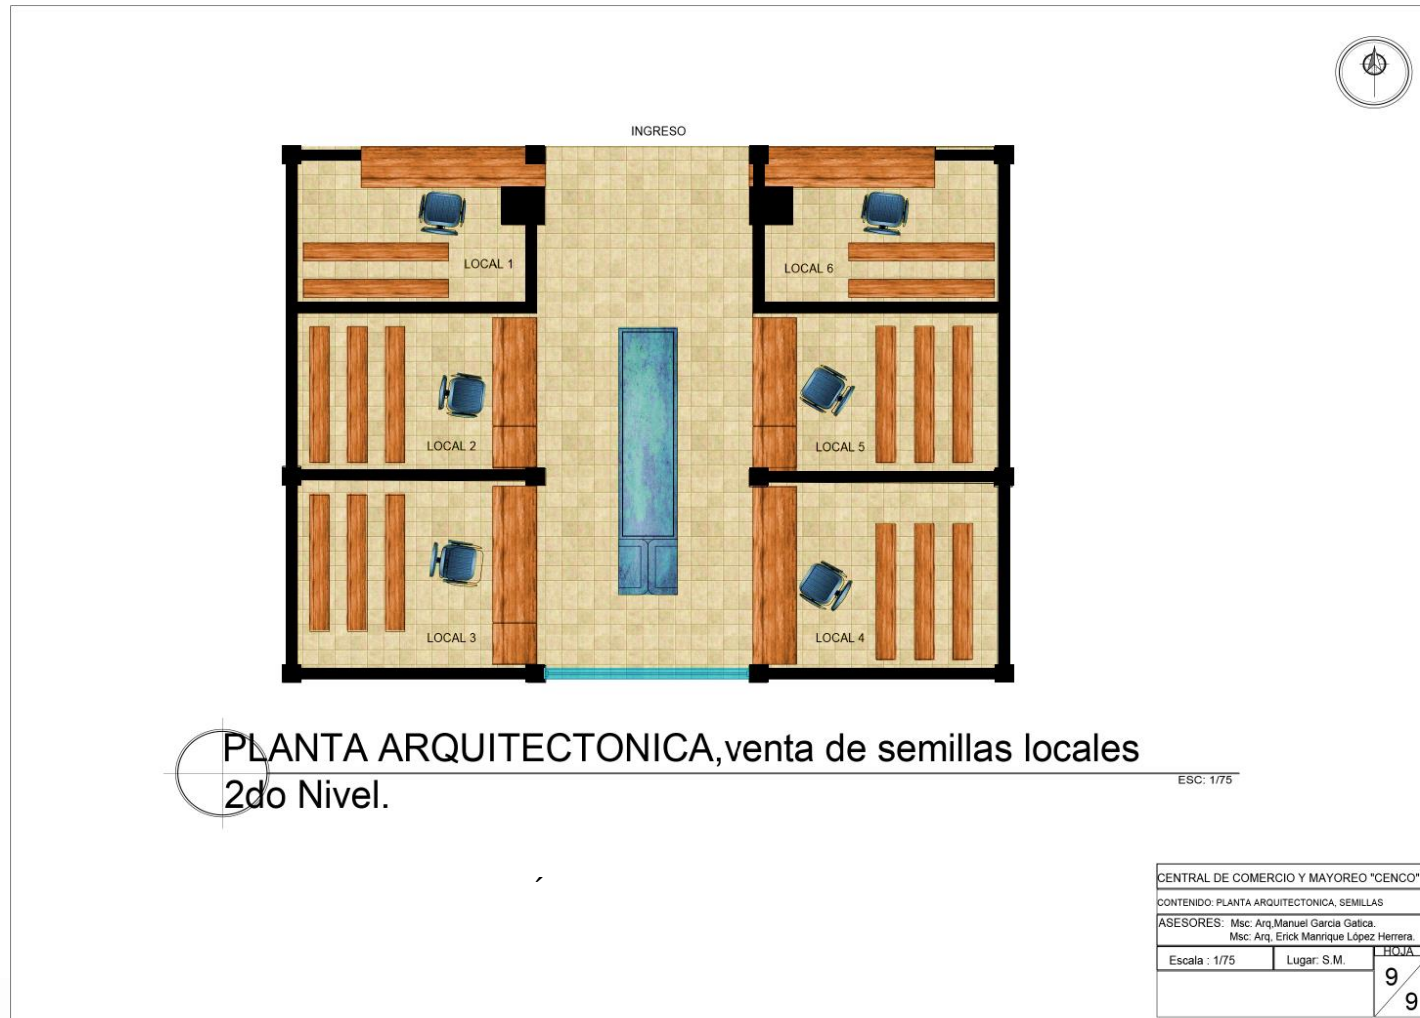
Planta arquitectónica, venta de hortalizas y semilla
